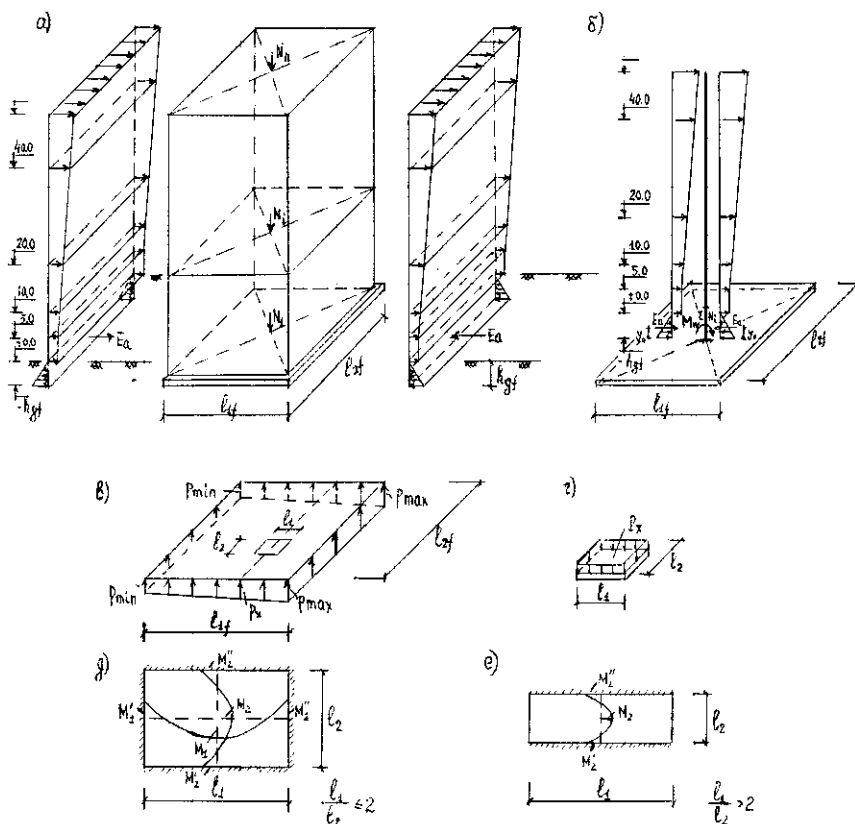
Расчётные схемы к определению отпора грунта в сплошных фундаментах высотных зданий: а — характер действия вертикальных и горизонтальных нагрузок, б — расчётная схема высотного здания, в, г — эпюры отпора грунта по подошве сплошного фундамента и в пределах его отсека, д, е — эпюры изгибающих моментов в отсеке сплошного фундамента при его опирании по контуру и по двум сторонам
